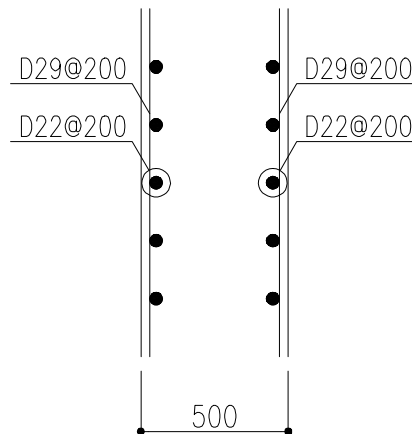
耐震壁の配筋図 (3階9通り B~C通り間)
